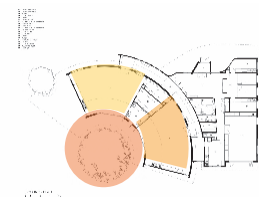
Planta baja centro de familia Wellington. Fuente: Archdaily
